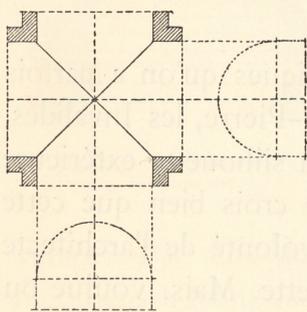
Voûte d'arête cylindrique sur plan carré.
